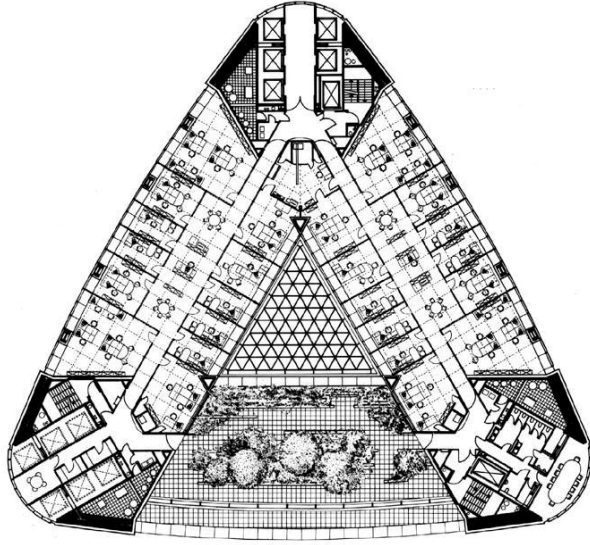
Eko Ev- Kat planı ve kesitler
